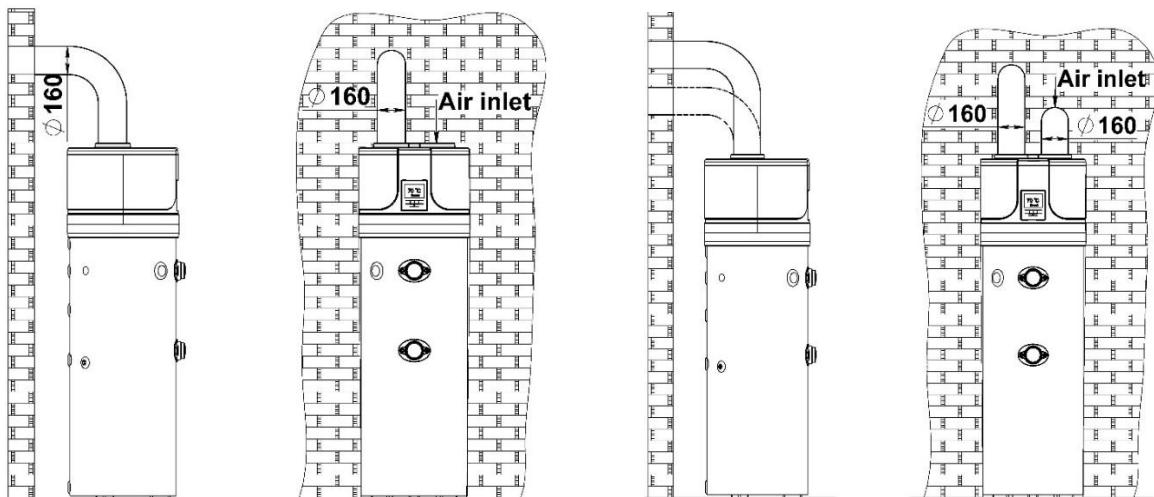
Exemple de conduit d'échappement d'air Fig. 5b – Exemple de double conduit d'air
